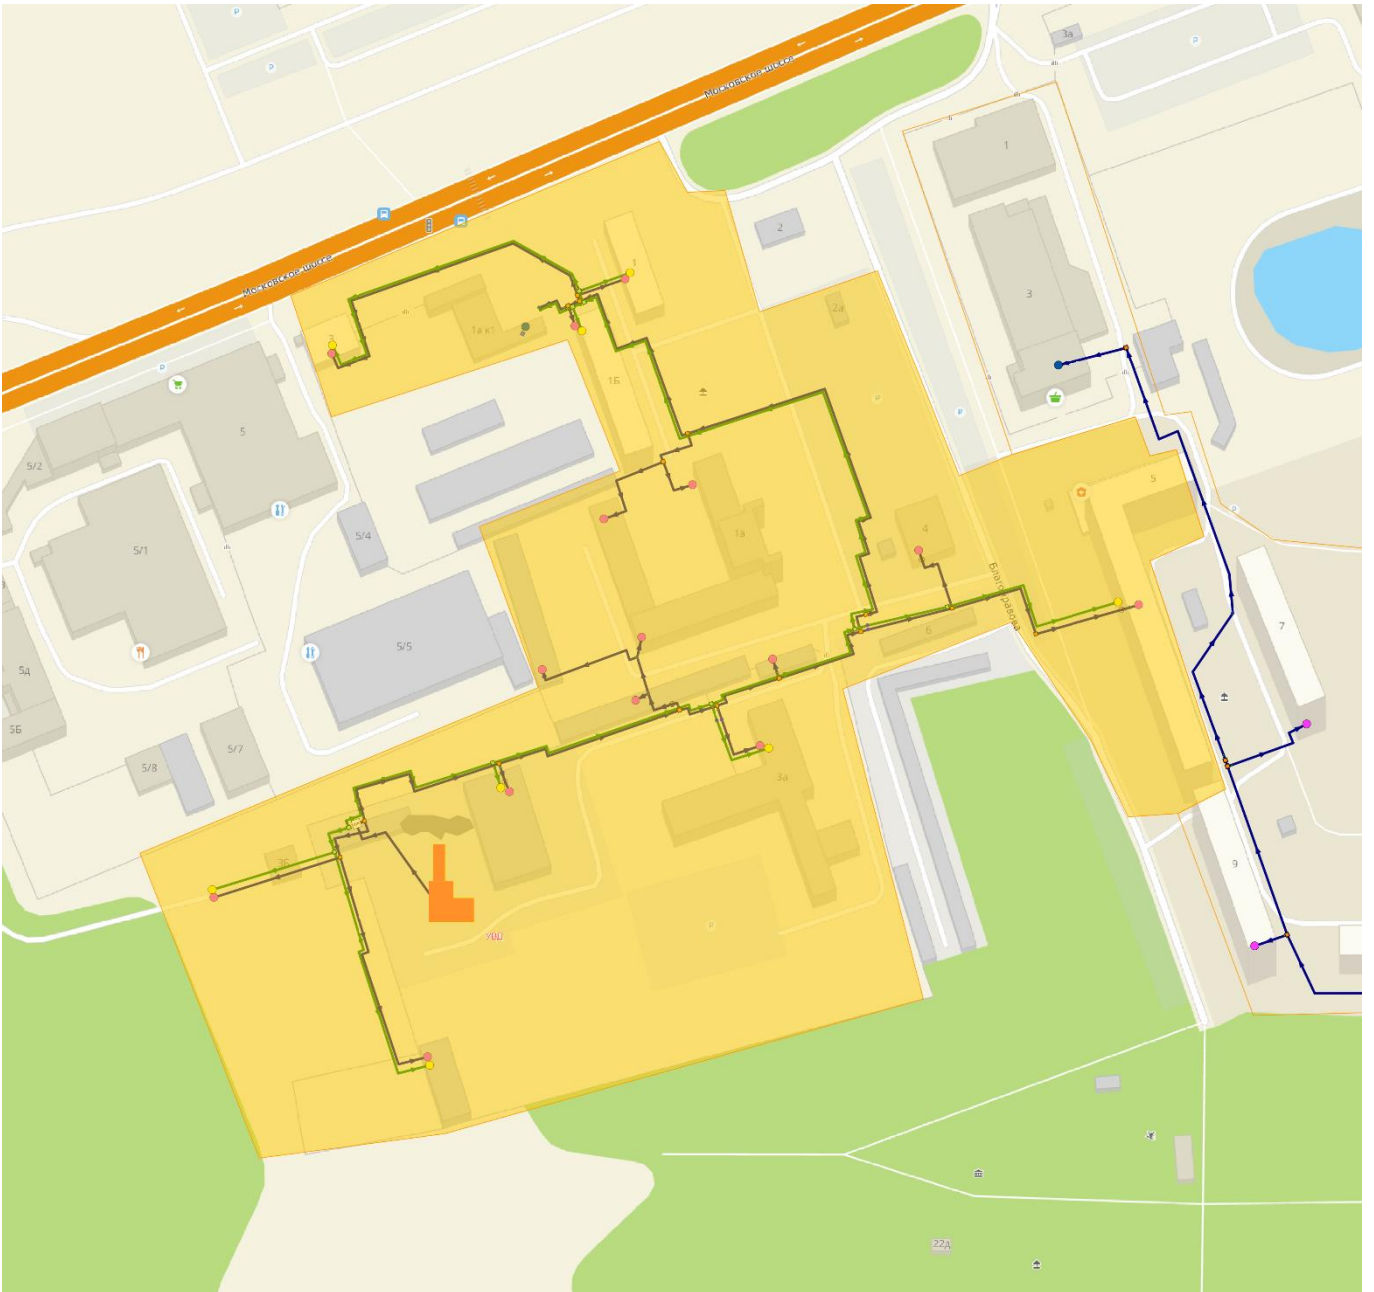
Схема тепловых сетей системы теплоснабжения котельной УВД (ЕТО-1)
